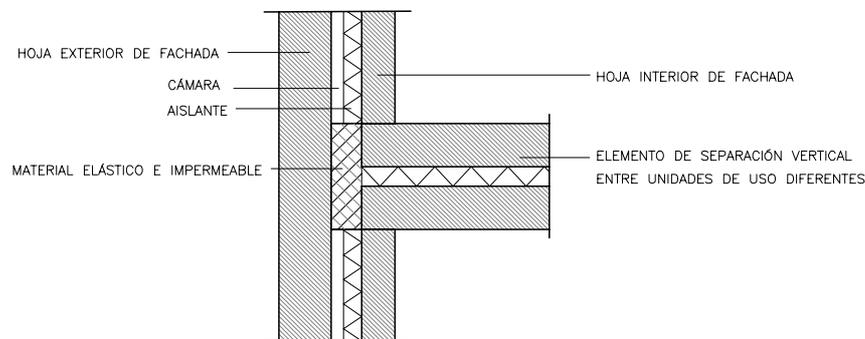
Vista en planta del encuentro de un elemento de separación vertical de dos hojas de fábrica con una fachada.
